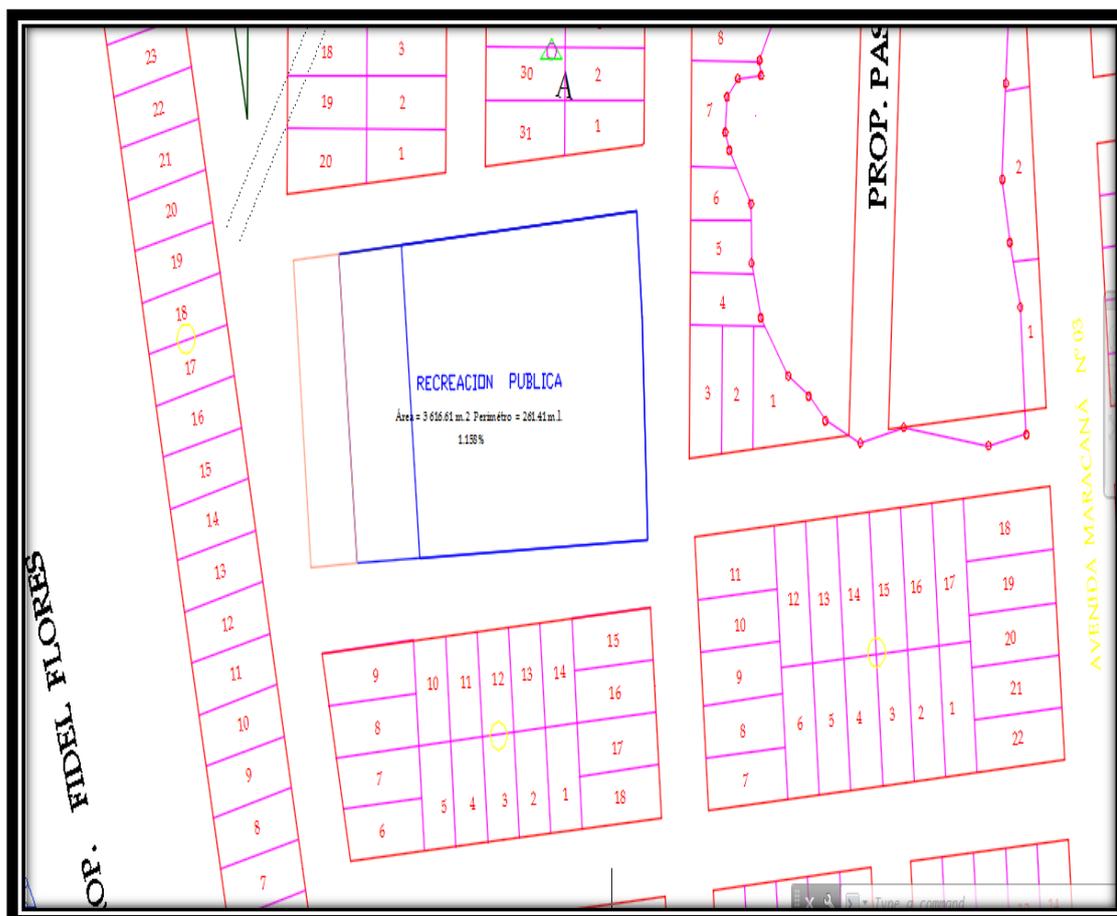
Plano ubicación del terreno donde se desarrollara el proyecto
